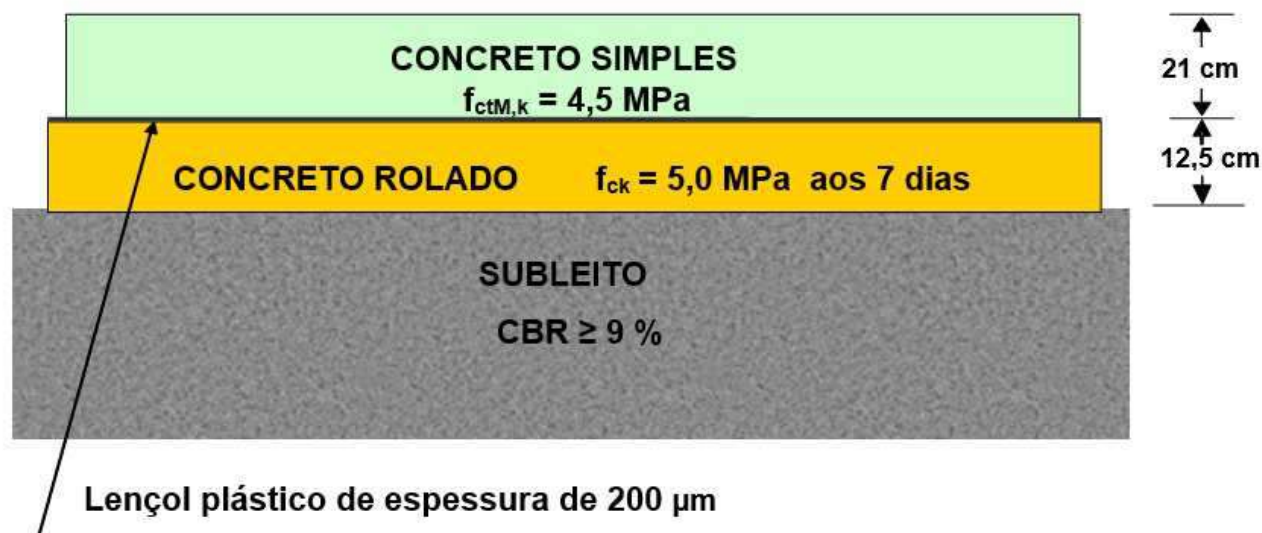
Estrutura de pavimento rígido da Av. Samdu.
